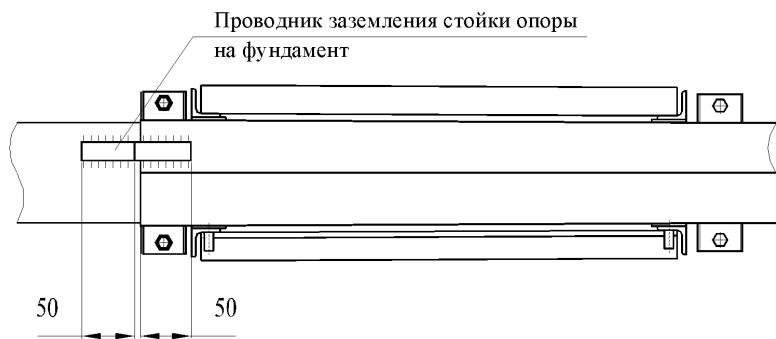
Заземление стойки опоры на трубу фундамента
